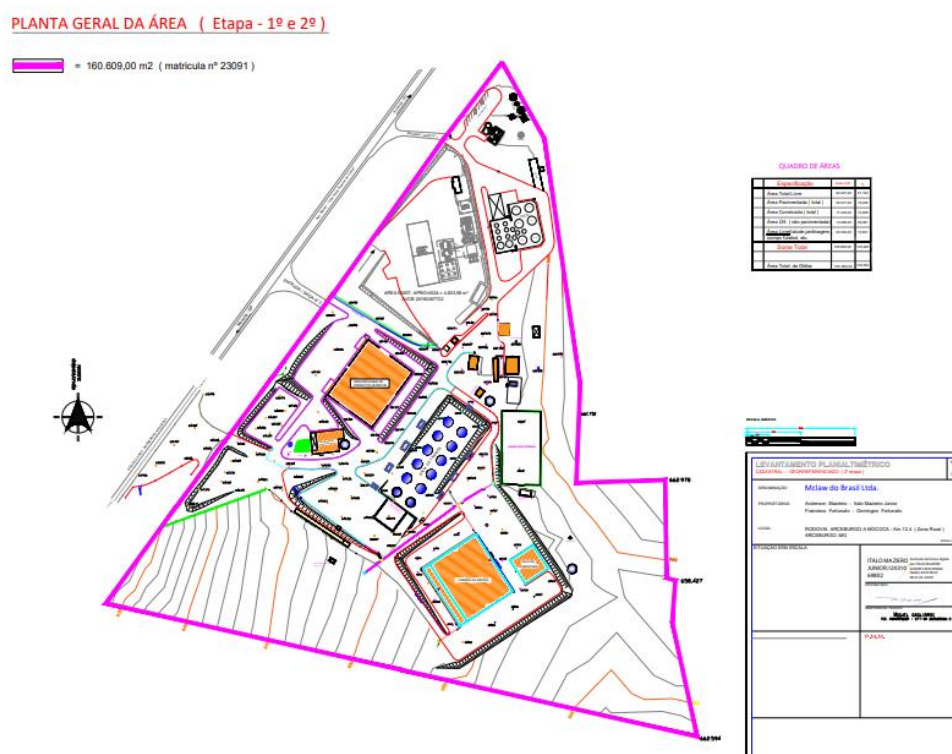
Levantamento planialtimétrico da MCLAW DO BRASIL LTDA. Fonte: SLA
